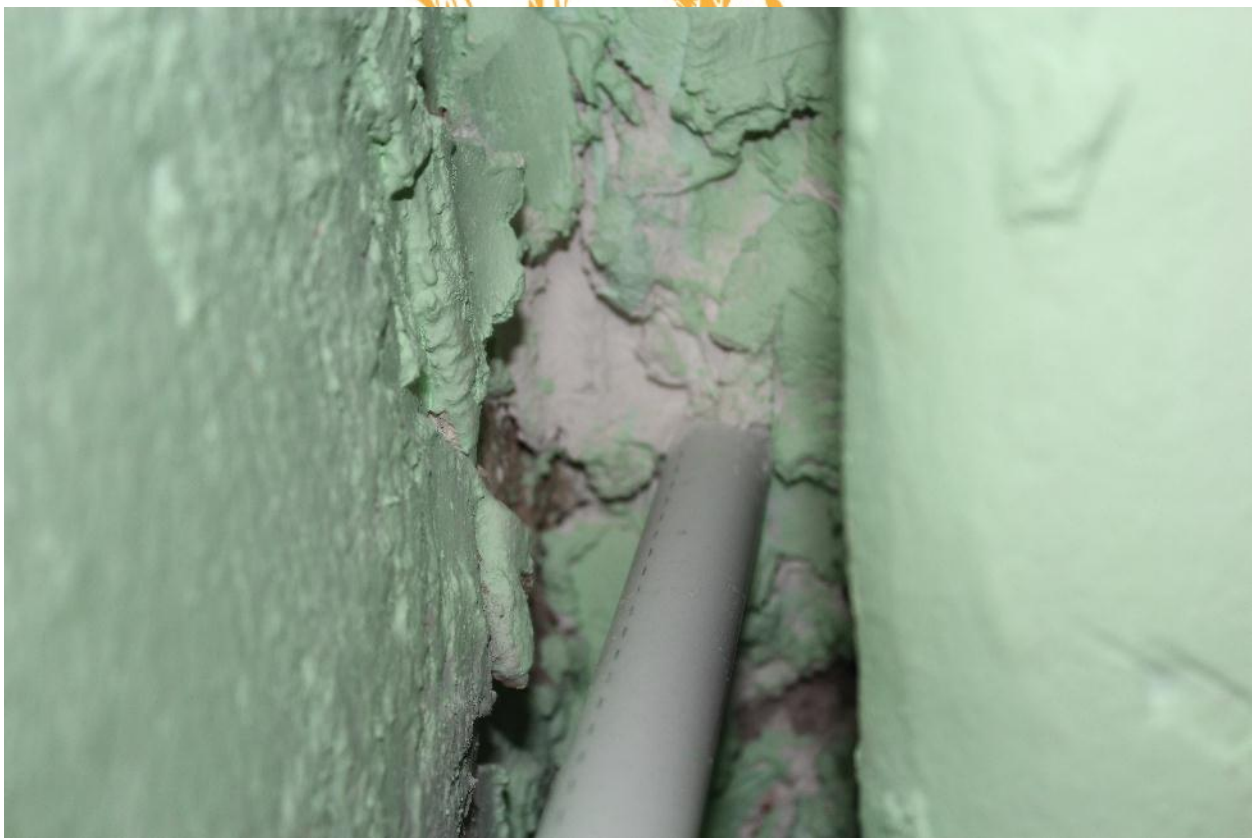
Примыкание трубопровода к строительным конструкциям.
